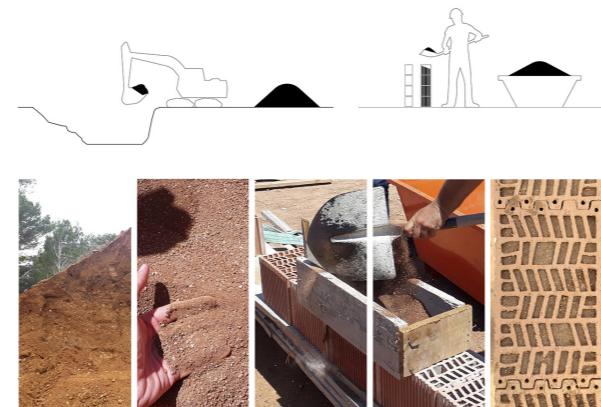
Aislamiento a base de rellenar con tierra de excavación los muros de bloques de termoarcilla.
